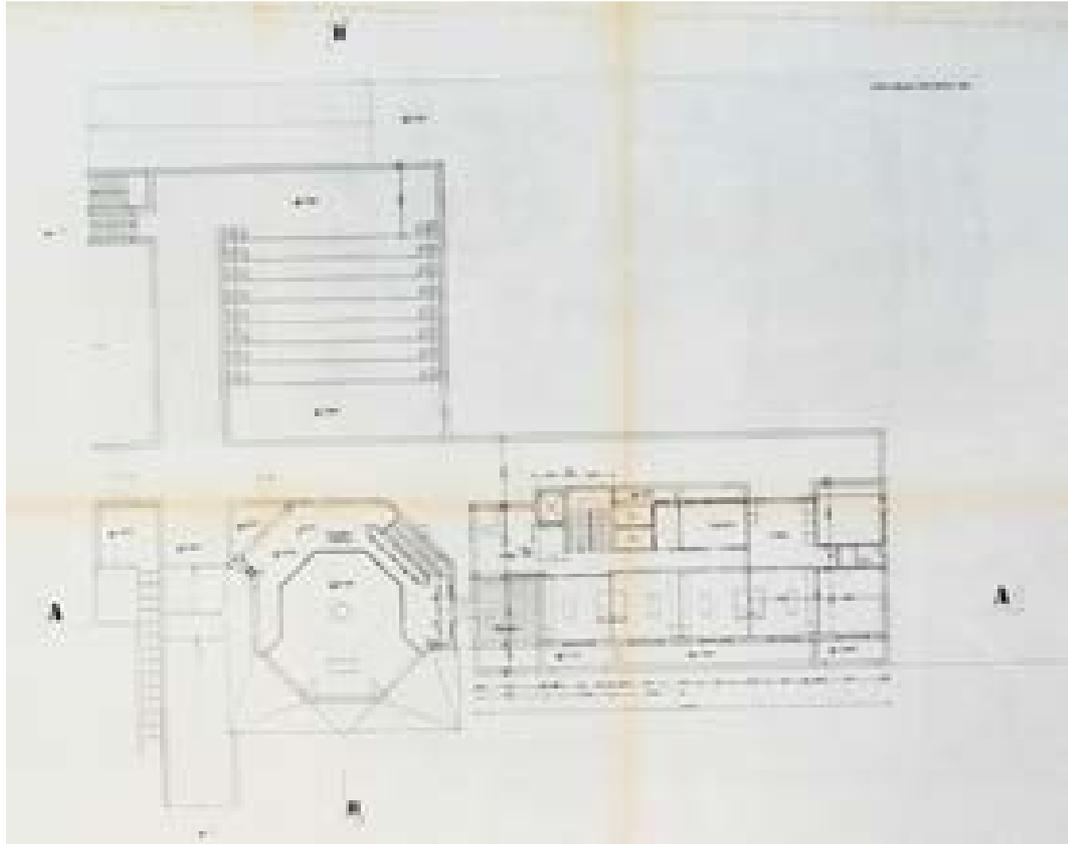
Pianta +4,00, stato sovrapposto – 02/11/1999 (AABS-64_1108)
